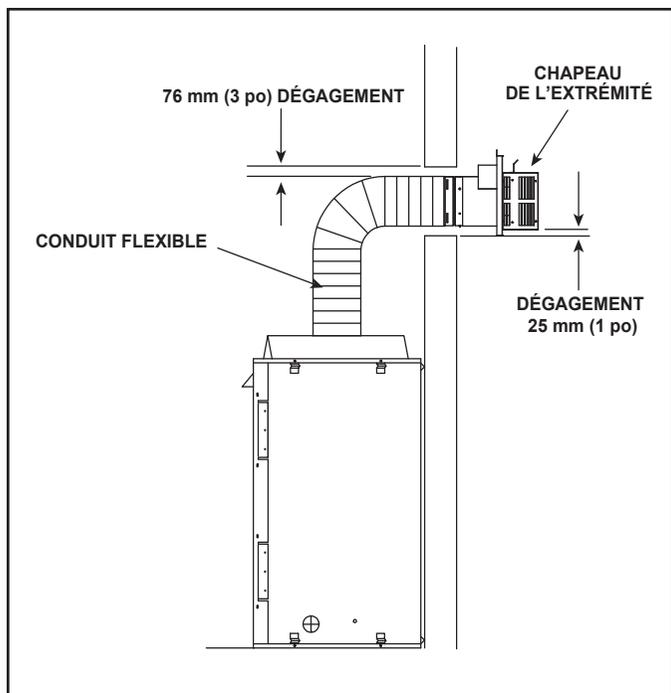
Conduit d'évacuation flexible – Foyer générique illustré
